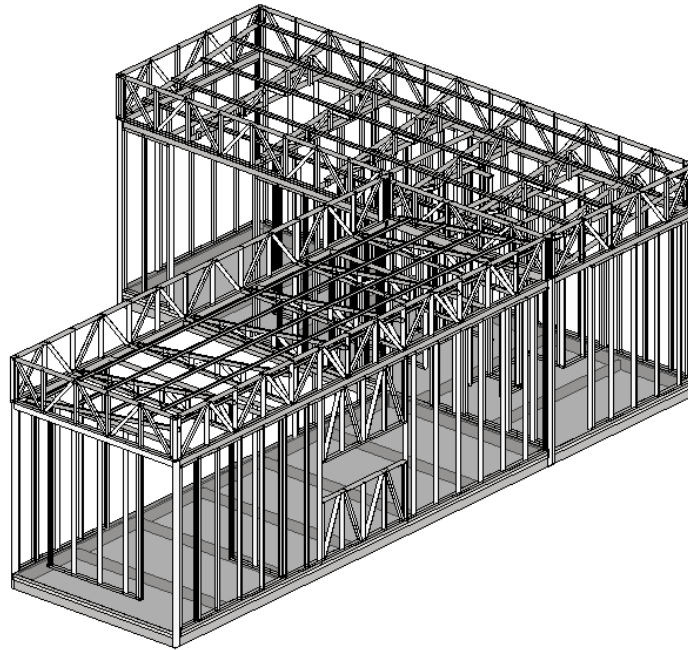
Vista Isométrica Steel Frame Casa Cero.
